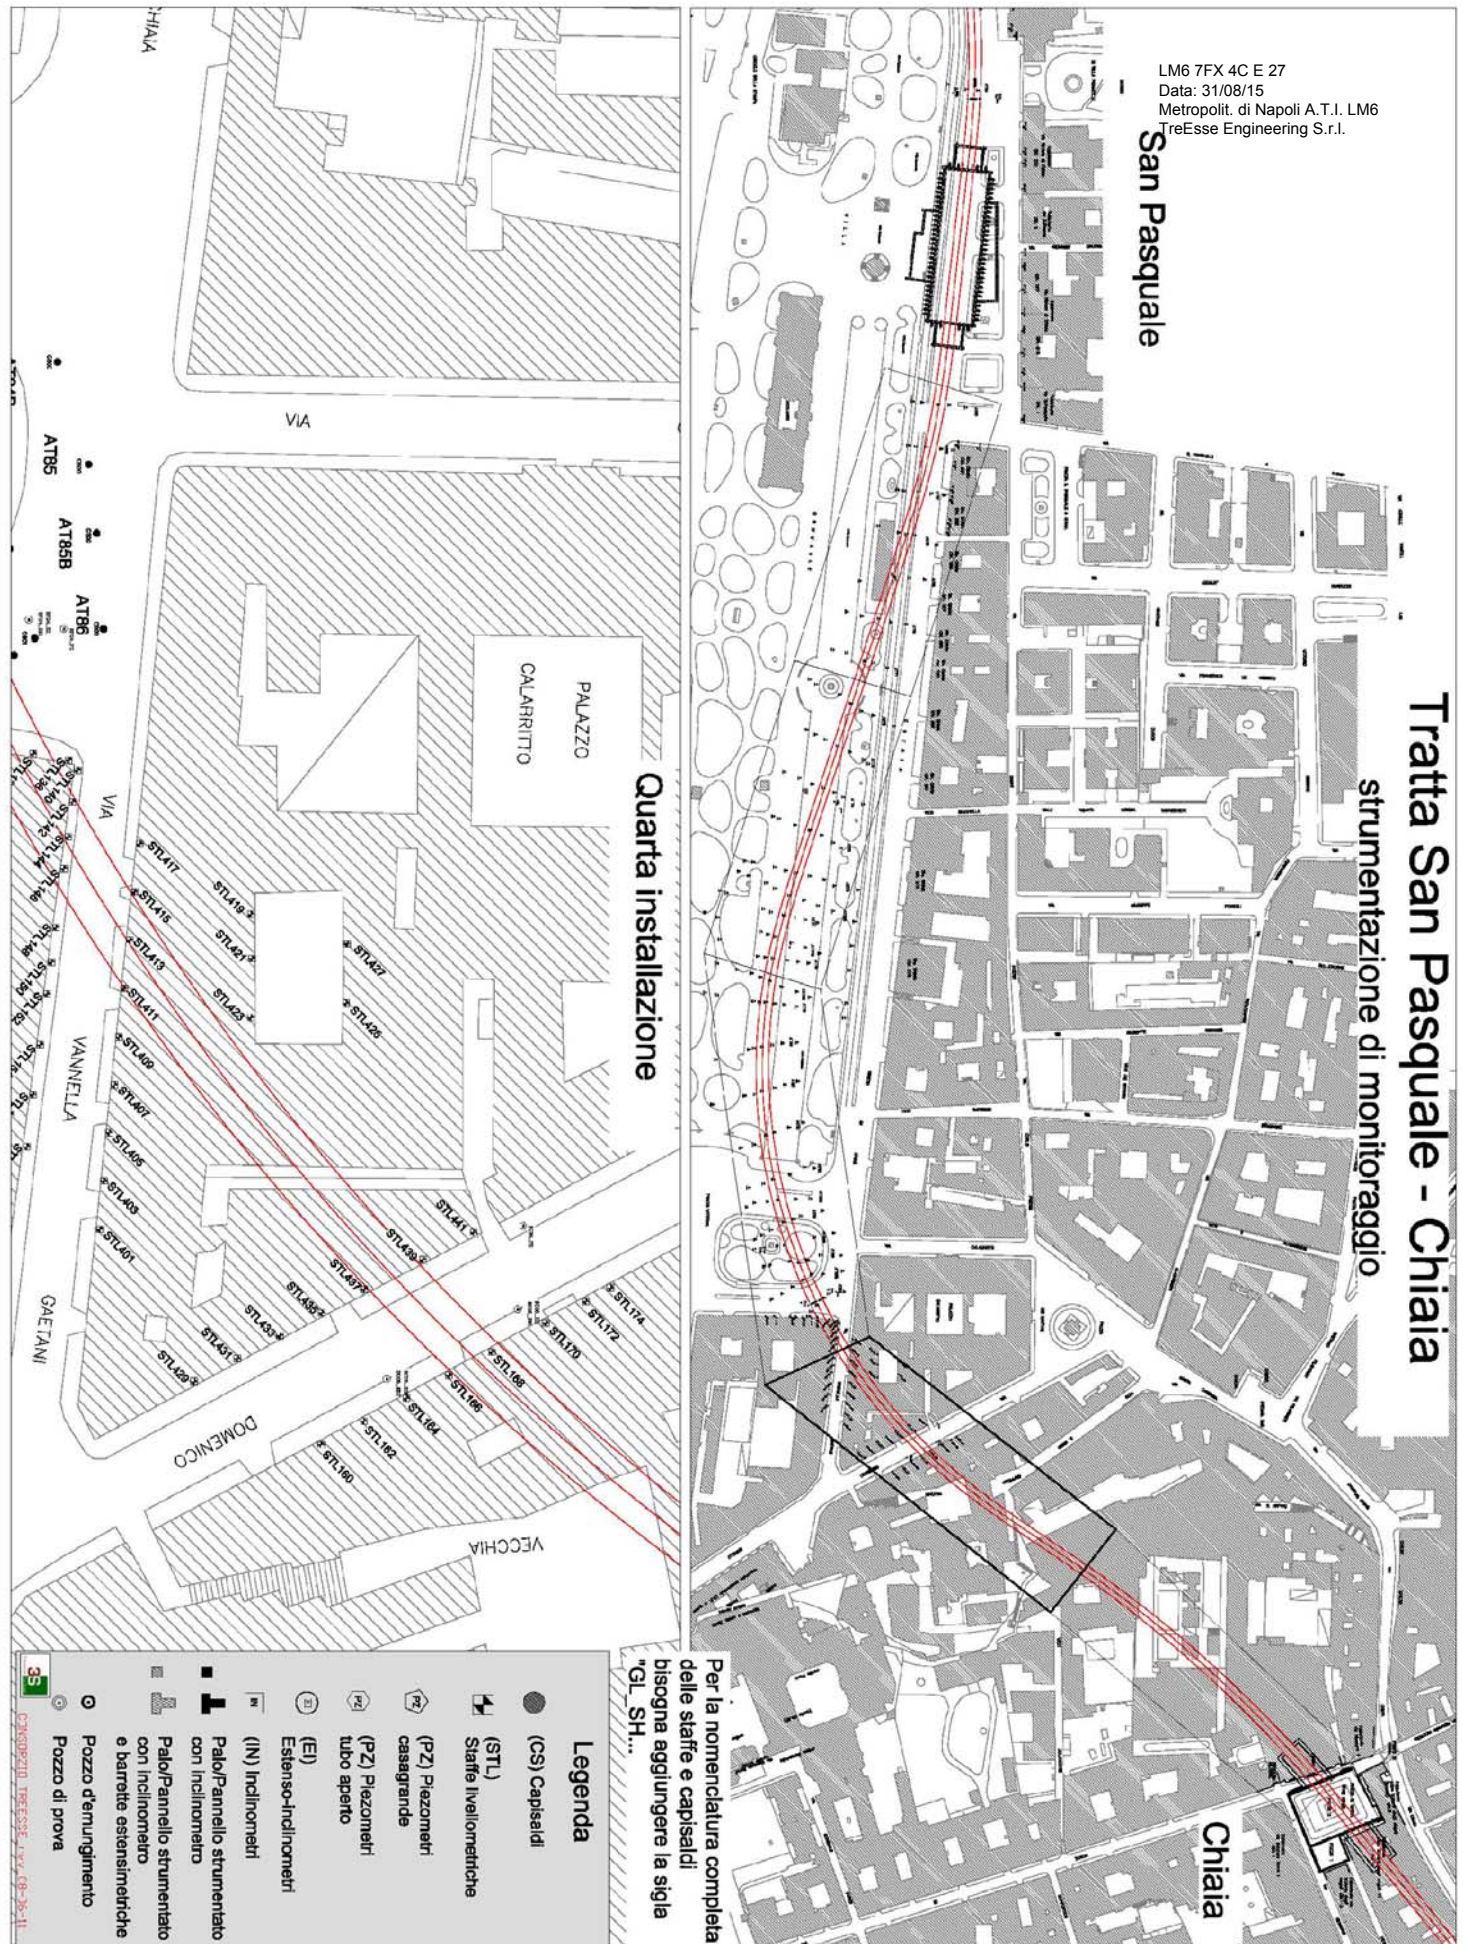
Planimetria tratta San Pasquale - Chiaia, raffigurante la disposizione della quarta installazione della strumentazione di monitoraggio.
